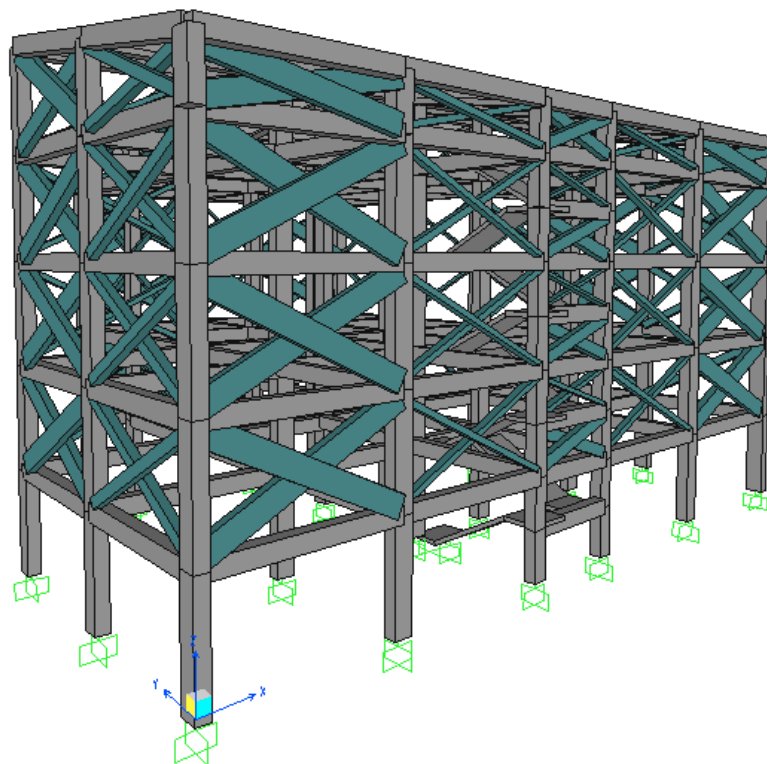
Vista 3D dell'edificio con piano terra a pilotis
